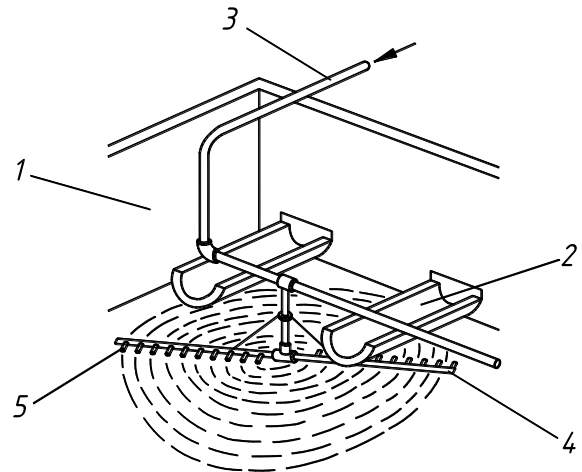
Схема обертового пристрою для верхнього промивання швидкого фільтра: 1 – стінка фільтра; 2 – жолоб для відведення промивної води; 3 – розподільний трубопровід; 4 – горизонтальний обертовий трубопровід; 5 – конусна насадка
